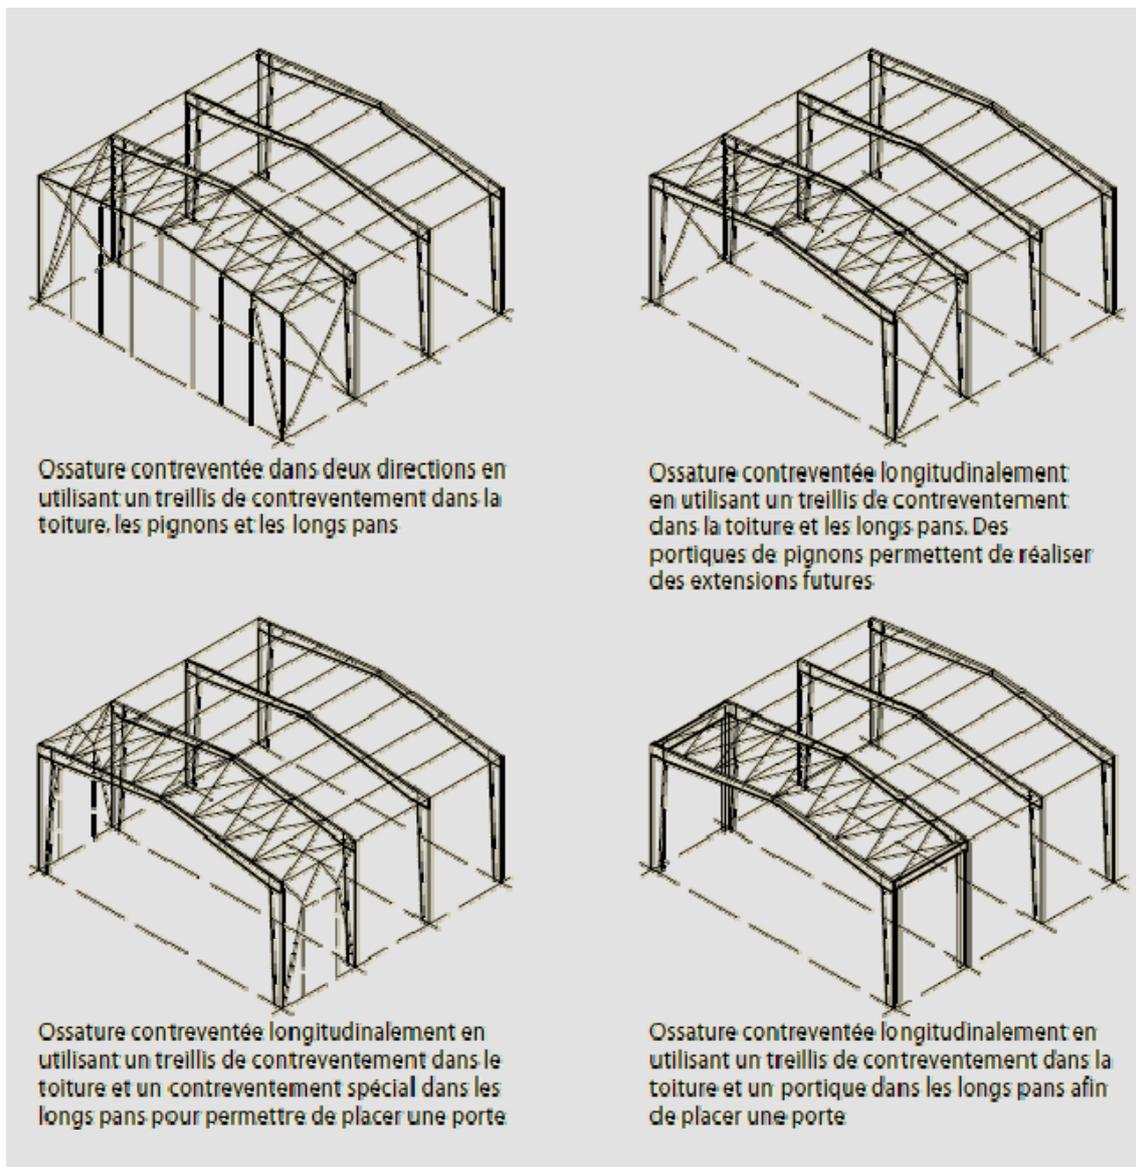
Exemples de contreventement hors du plan d'un portique
